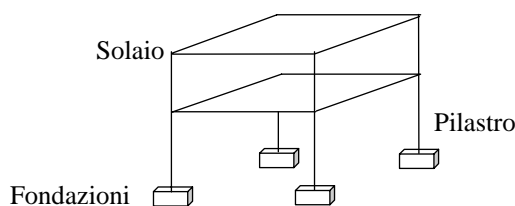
Elementi strutturali di un edificio, schematizzati a seconda delle rispettive caratteristiche geometriche (elementi mono-, bi-, tri-dimensionali).
